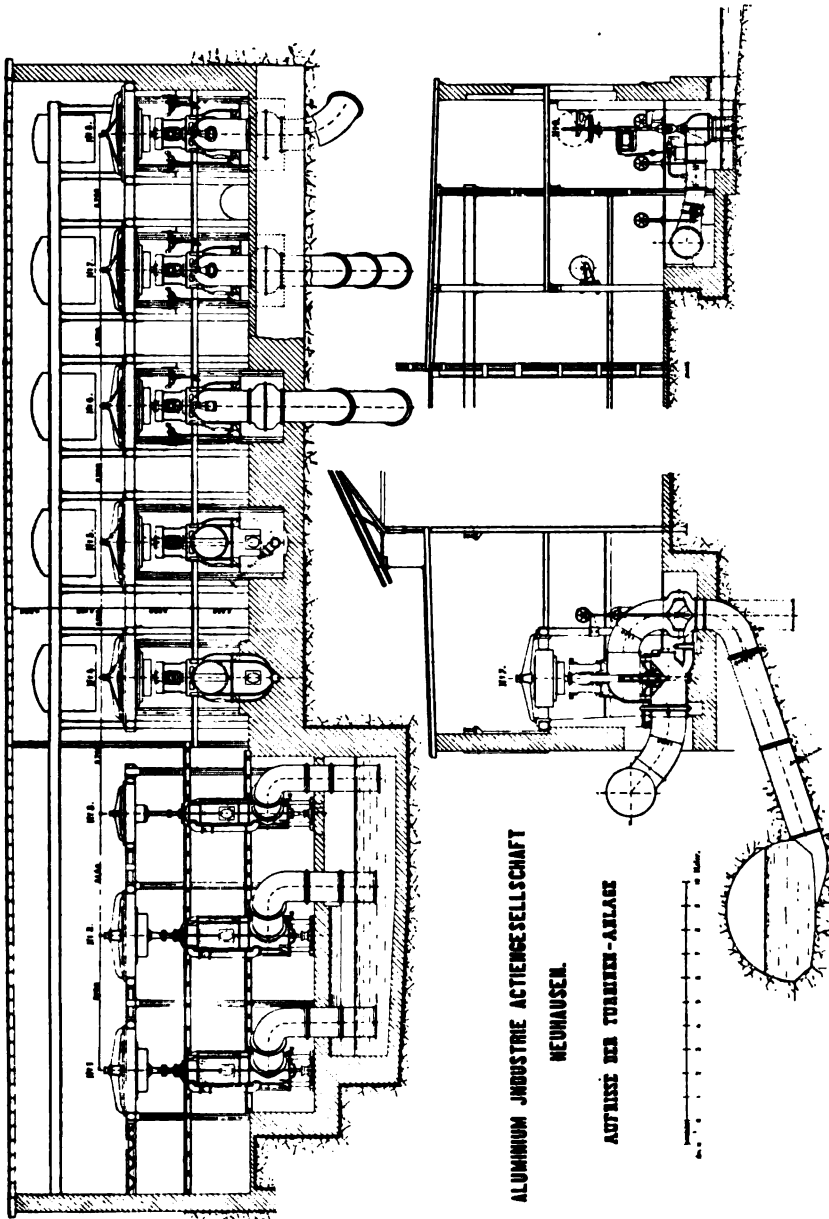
Turbinenanlage der Aluminiumindustrie-Aktiengesellschaft in Neuhausen.
